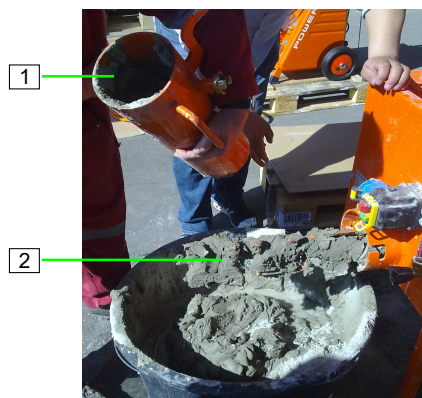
Nettoyer le tube de mélange et l'arbre de mélange
